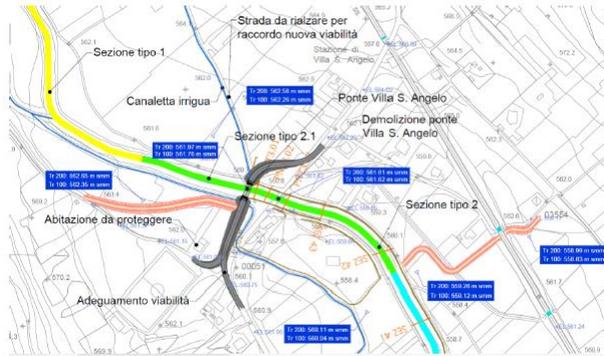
Estratto dalla planimetria degli interventi (tavola D.1.1) in zona Ponte Villa S. Angelo.
